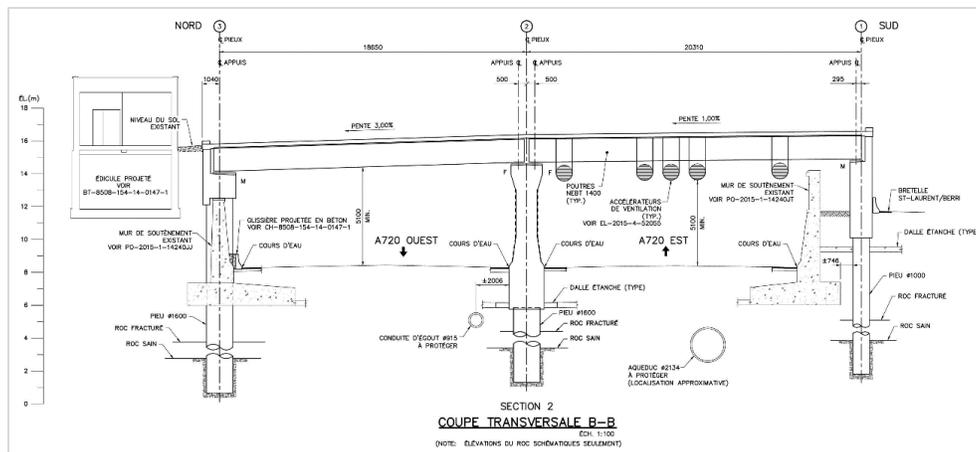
Coupe longitudinale du tablier vis-à-vis la section 2
